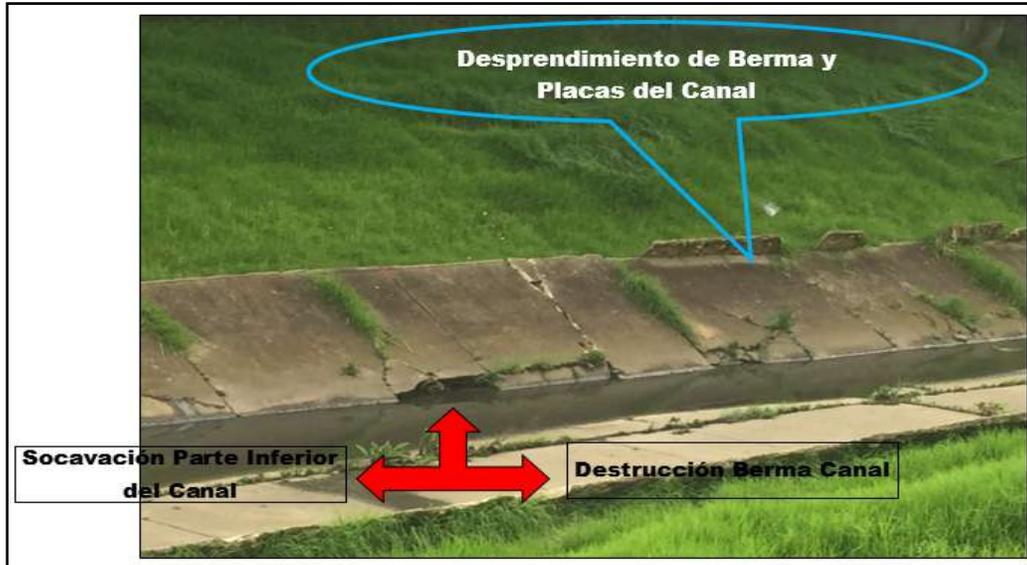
Mal estado de Placas y Vegetación presente entre las juntas de las placas de concreto del Canal Córdoba, Punto con Coordenadas: -74,053389 y Y=4,749056.
